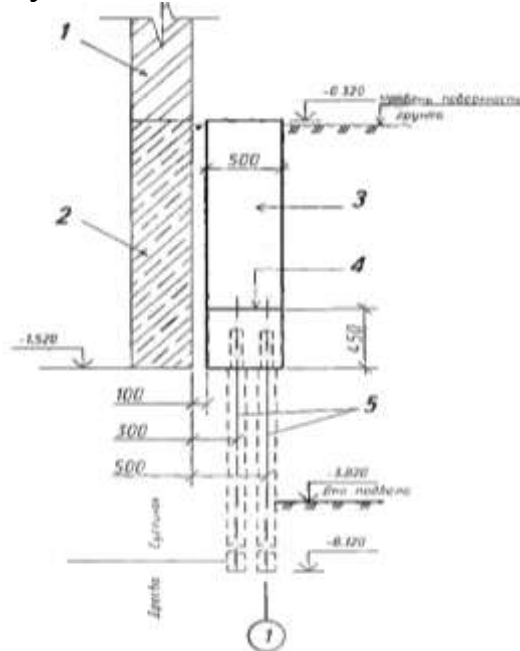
Конструкция пристраиваемого здания по оси фундамента; 1 – стена существующего здания; 2 – ленточный фундамент; 3 – монолитный фундамент нового здания; 4 – железобетонный ростверк; 5 – сваи диаметром 132 мм.
